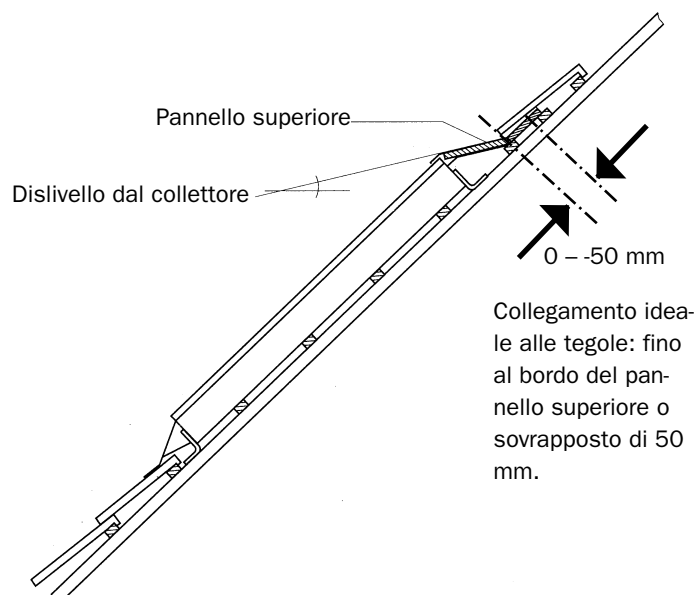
Vista in sezione del montaggio integrato nel tetto di SolvisFera
